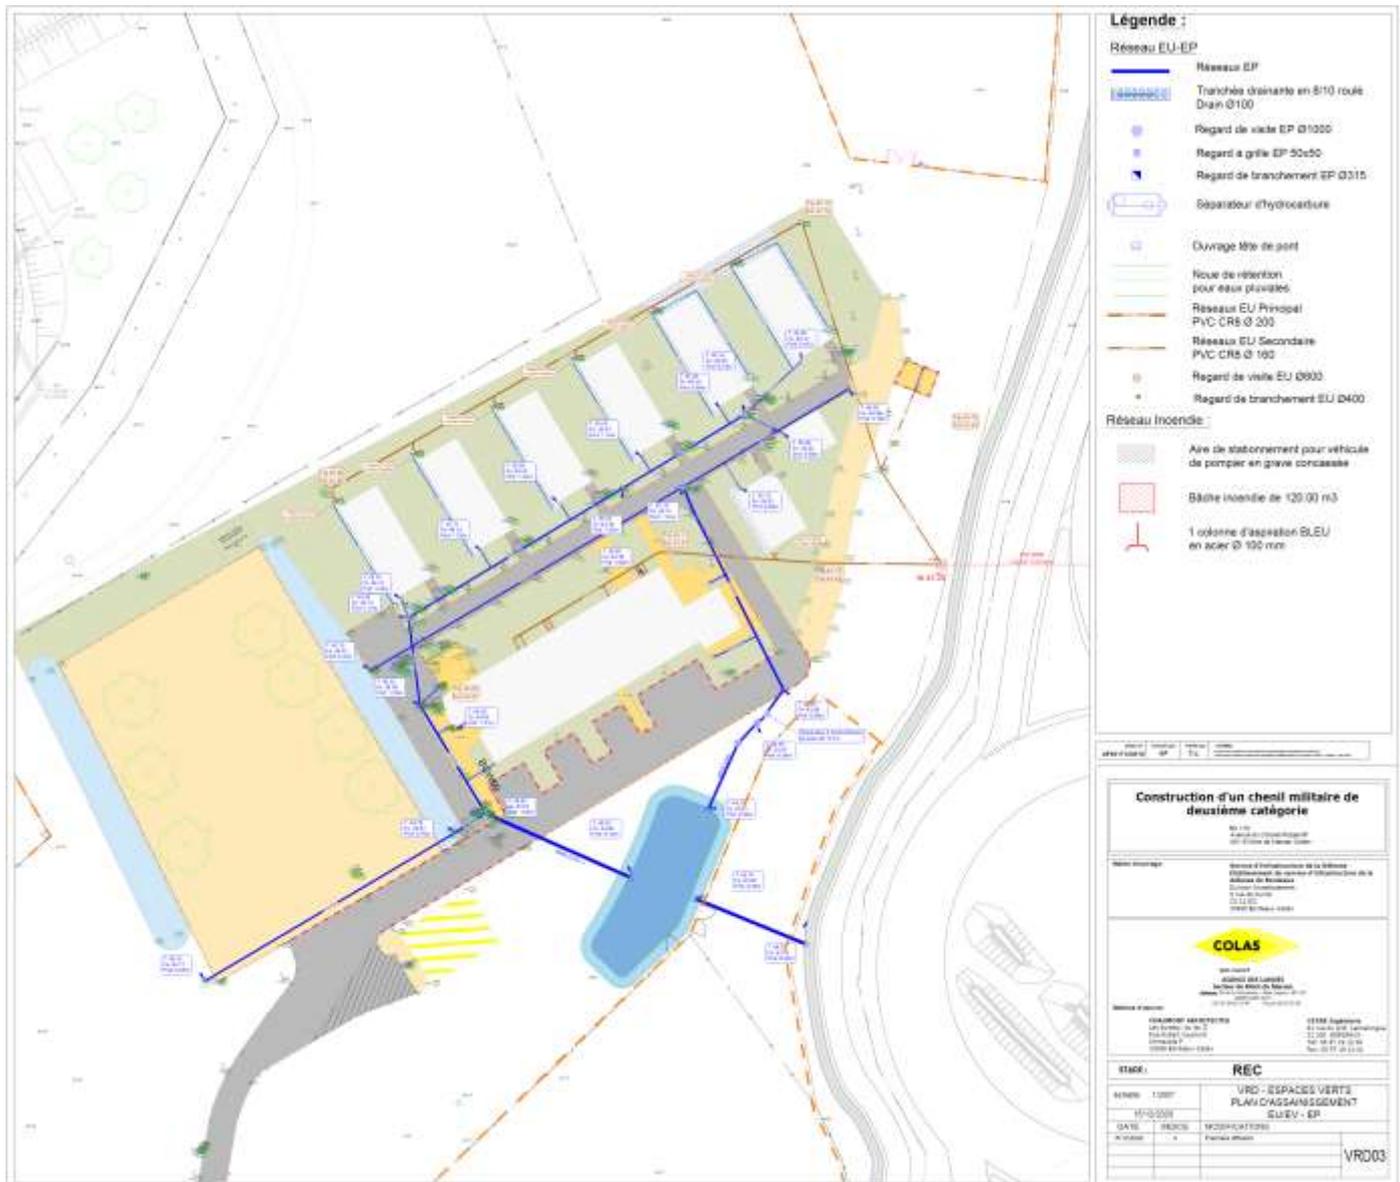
Plan de recollement du bassin de rétention situé au niveau du bâtiment chenil
